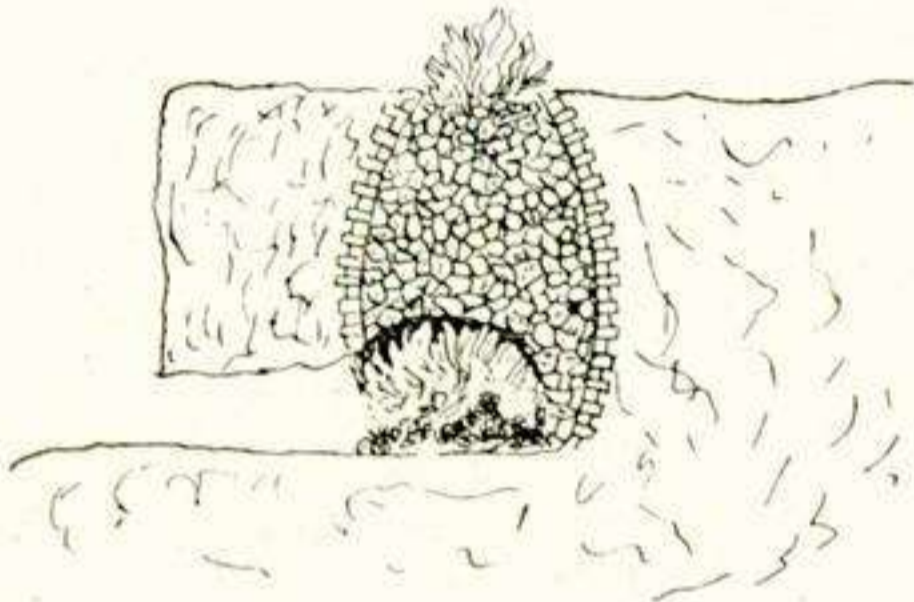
Sección de un horno de cal aprovechando un desnivel del terreno.
